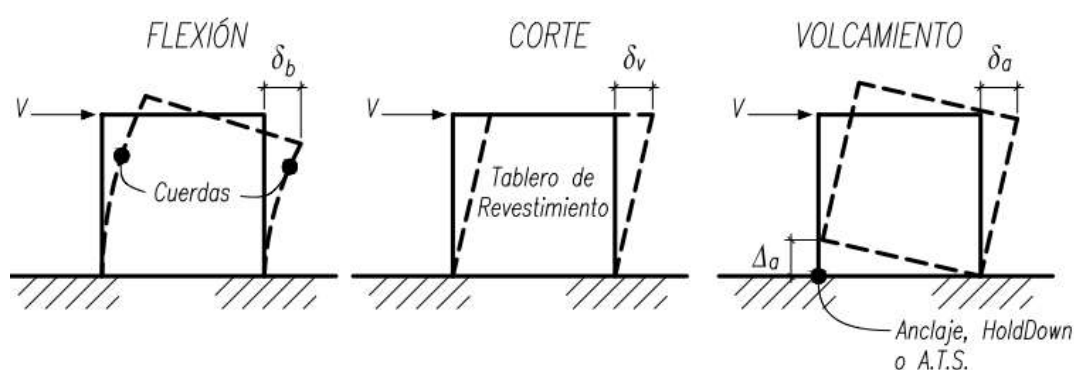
Comportamiento estructural de un muro de corte. Fuente: CIM UC
